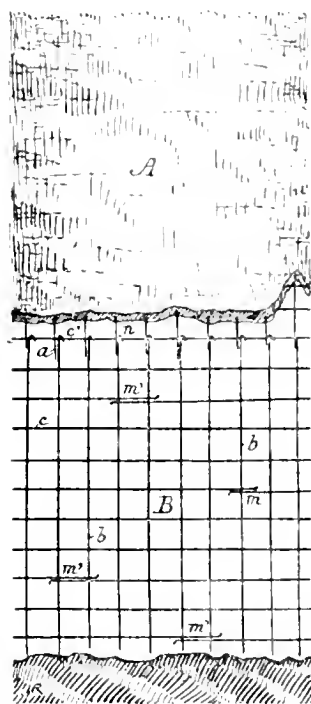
Développement de la paroi intérieure d'un puits en ciment armé.
